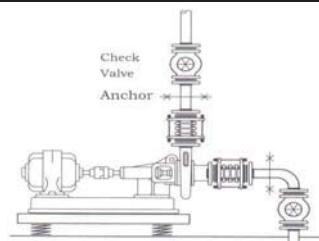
泵浦進、出口端。Pump : inlet/outlet
